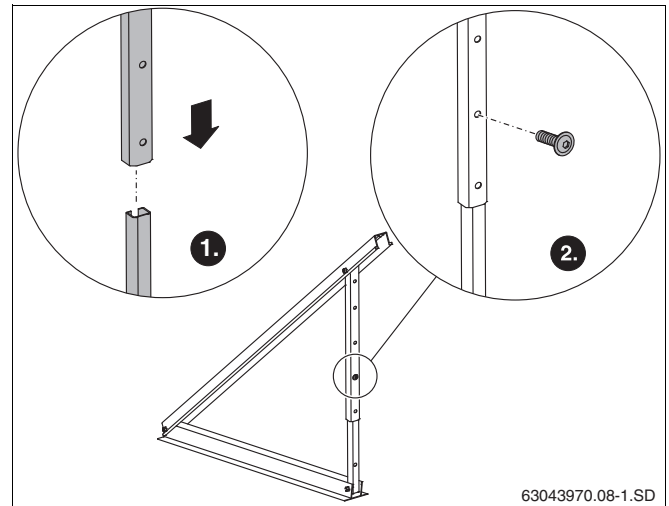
Ъгъл на монтаж на колектора върху фасада
